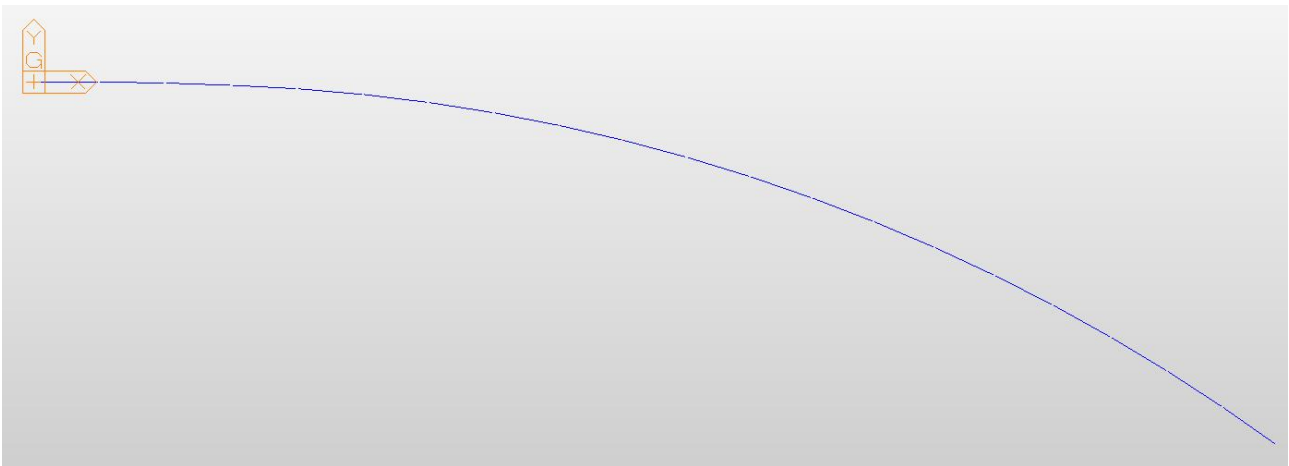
Andamento planimetrico del viadotto La Copeta
